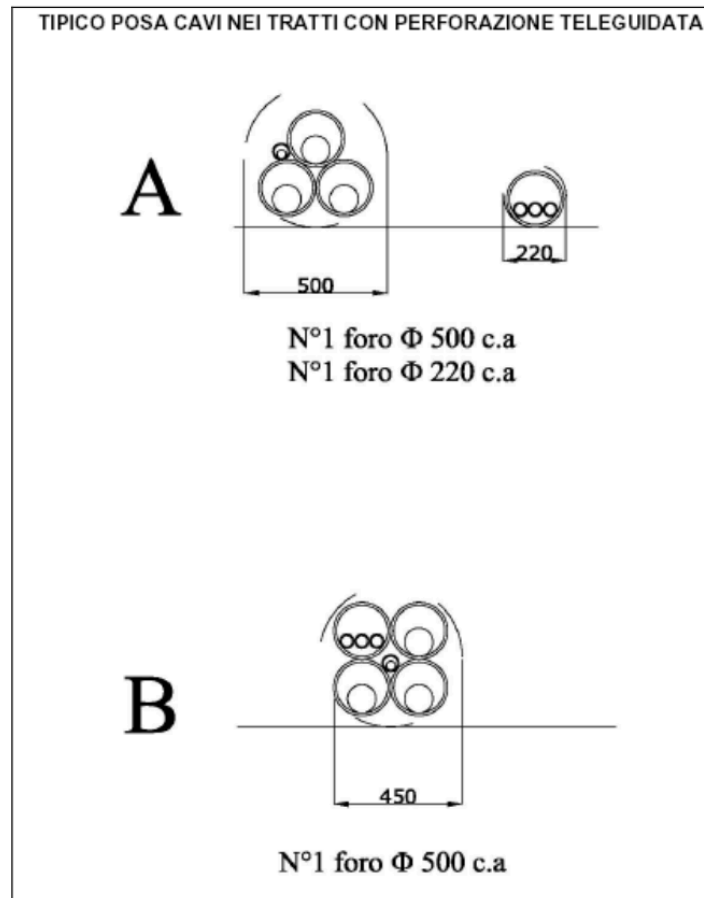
Sezione Tipo Attraversamento con foro pilota
